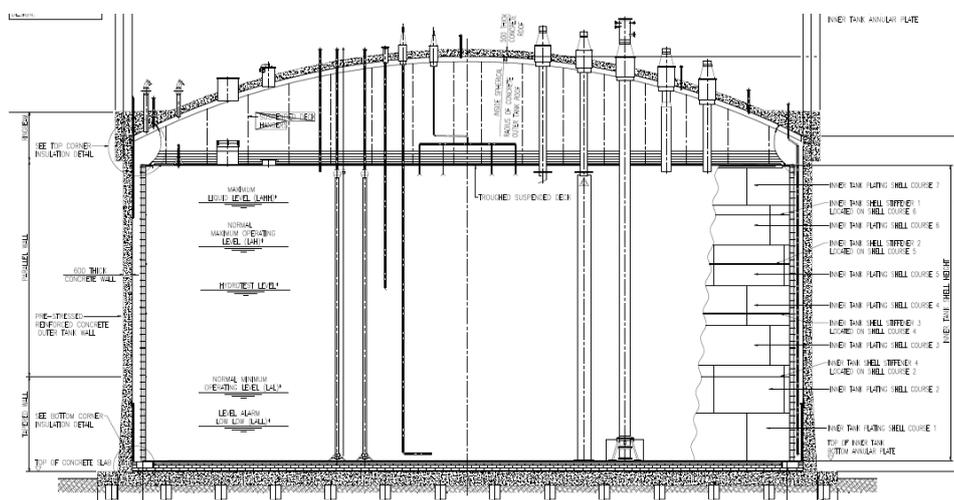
a: Serbatoio di Stoccaggio (Sezione)
